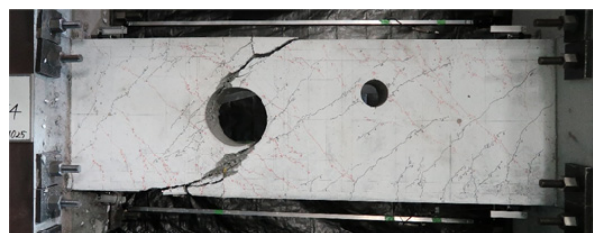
試験体破壊状況 (No. 19 : H/D=1/2.5)
